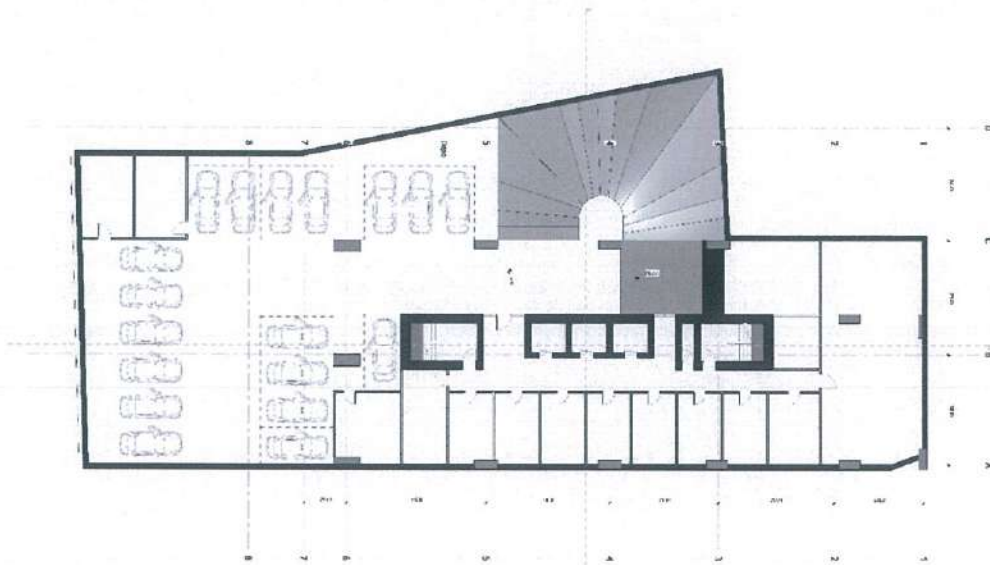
Plani i katit nëntoke -1, parkim në funksion të Hotelit
